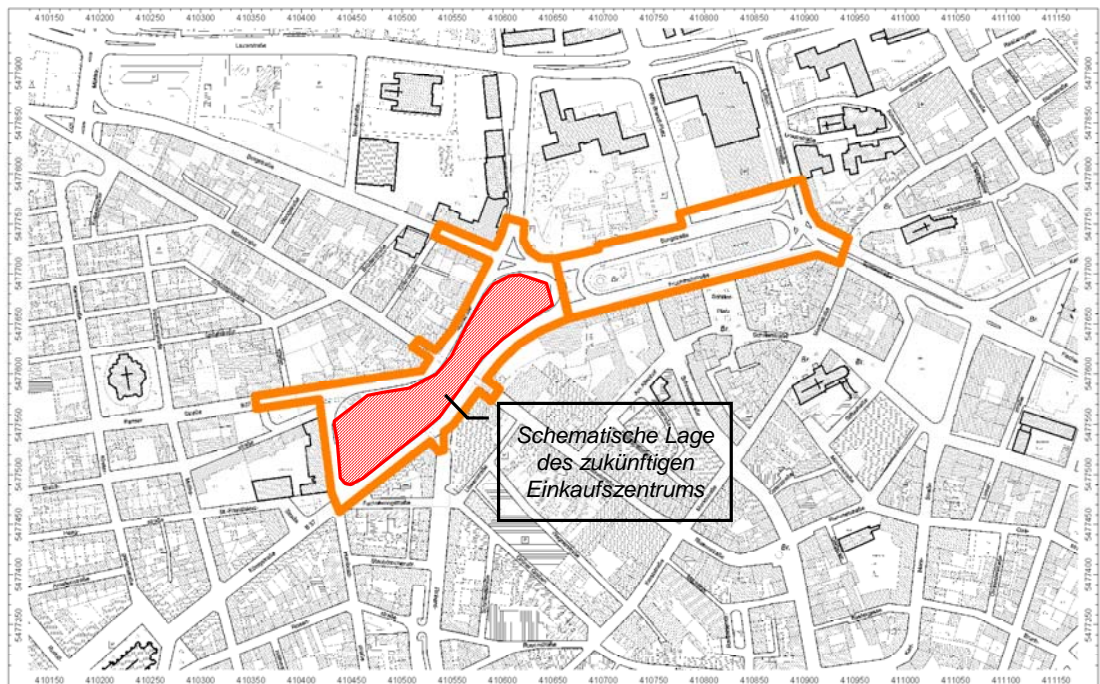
Lageplan mit Geltungsbereich der beiden Bebauungspläne und schematischer Darstellung des geplanten Einkaufszentrums (ohne Maßstab)
